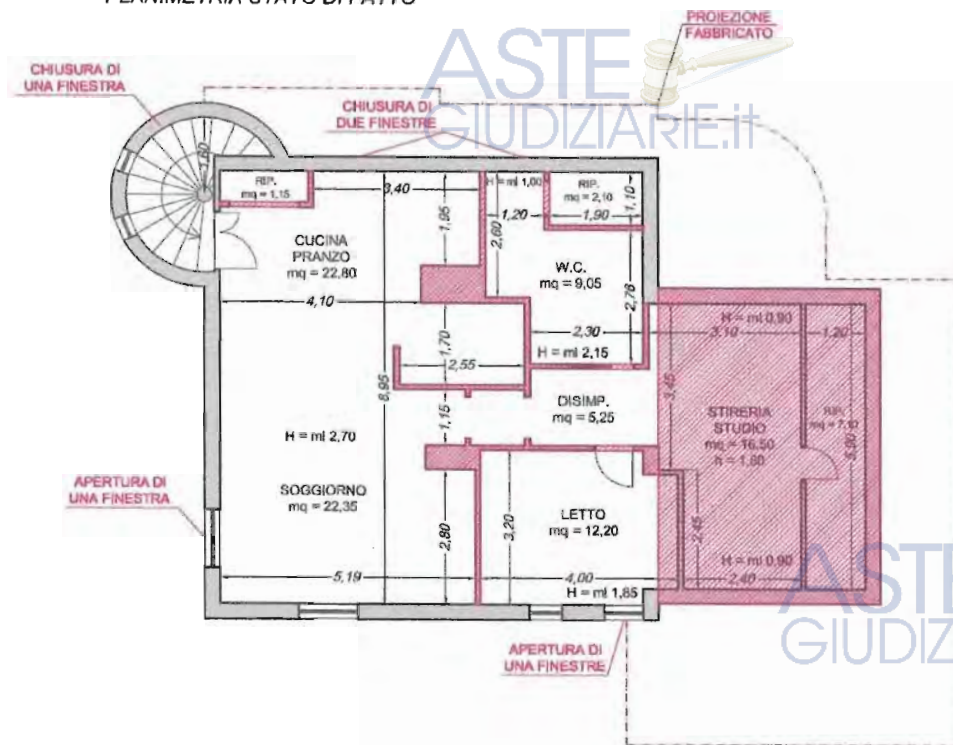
Planimetria Stato di Fatto Piano Sottotetto.
